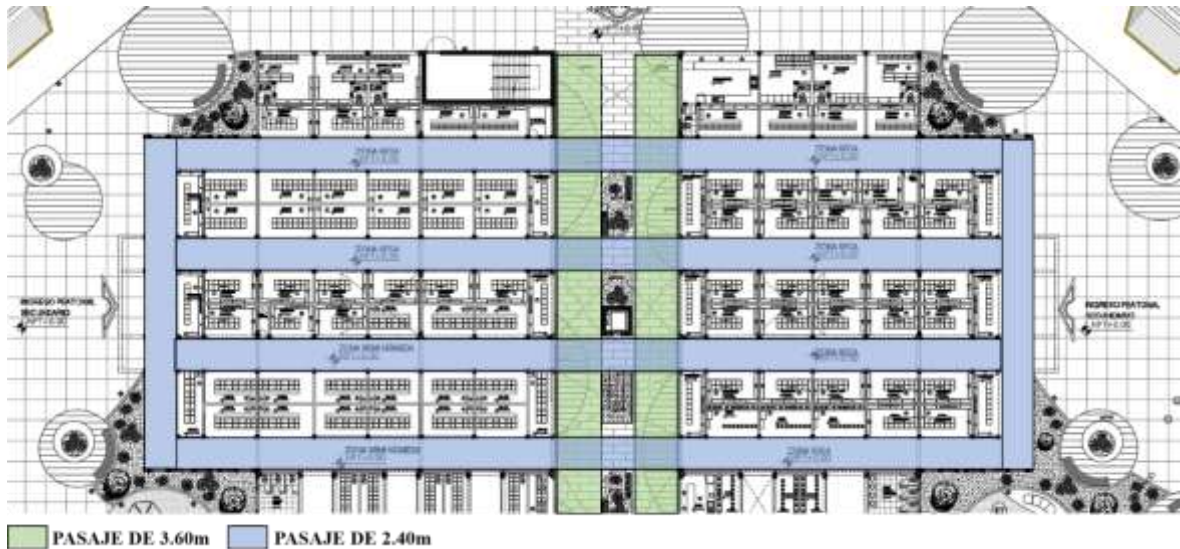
Medidas de pasajes de zona seca - Primer nivel
